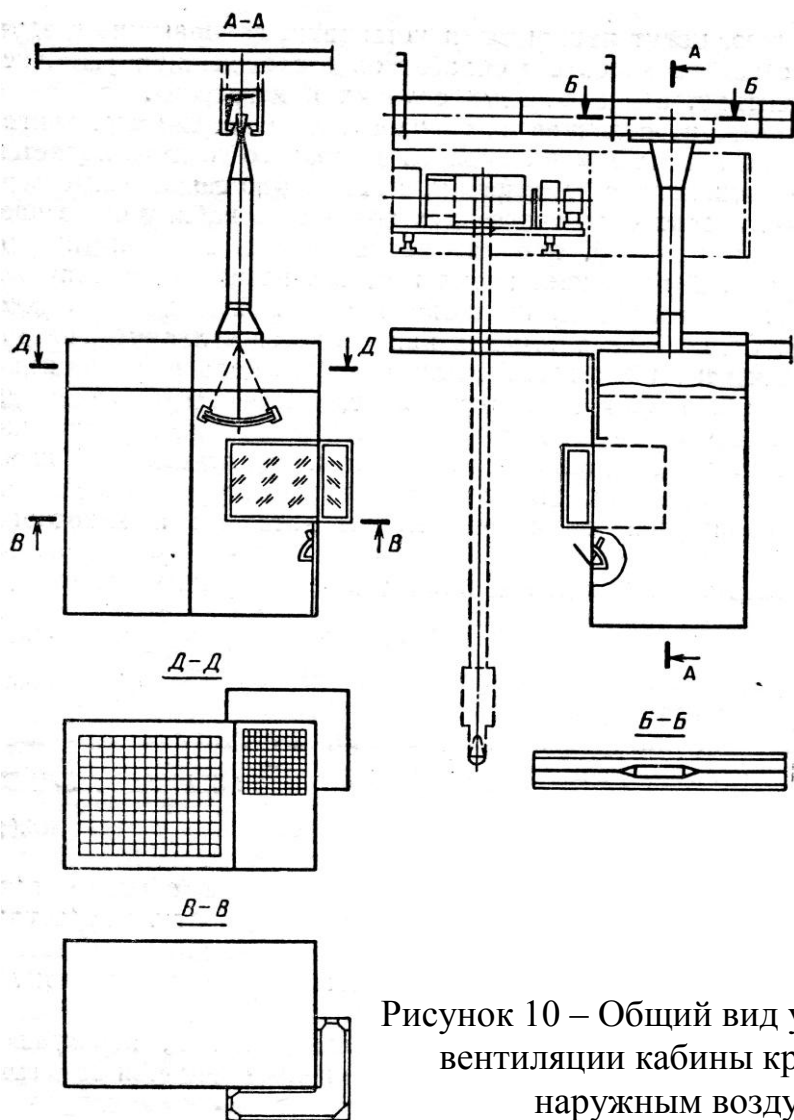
Общий вид установки для вентиляции кабины крановщика наружным воздухом
